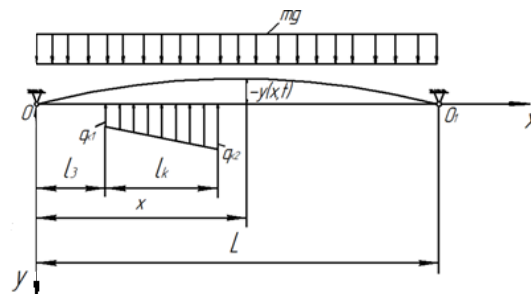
Расчётная схема блока кровли после хрупкого разрушения
